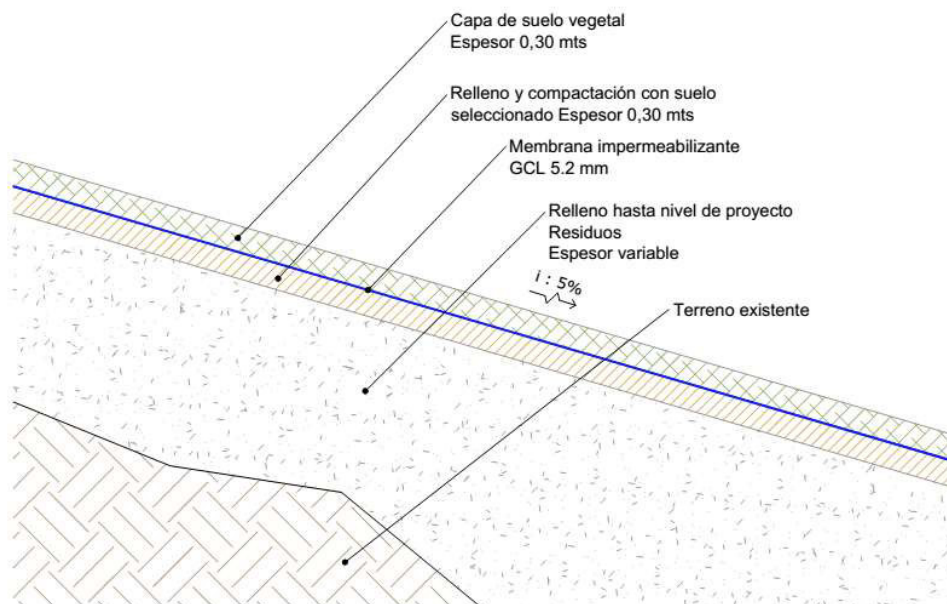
Paquete de Cierre de Módulo – Detalles Detalle paquete impermeable.
